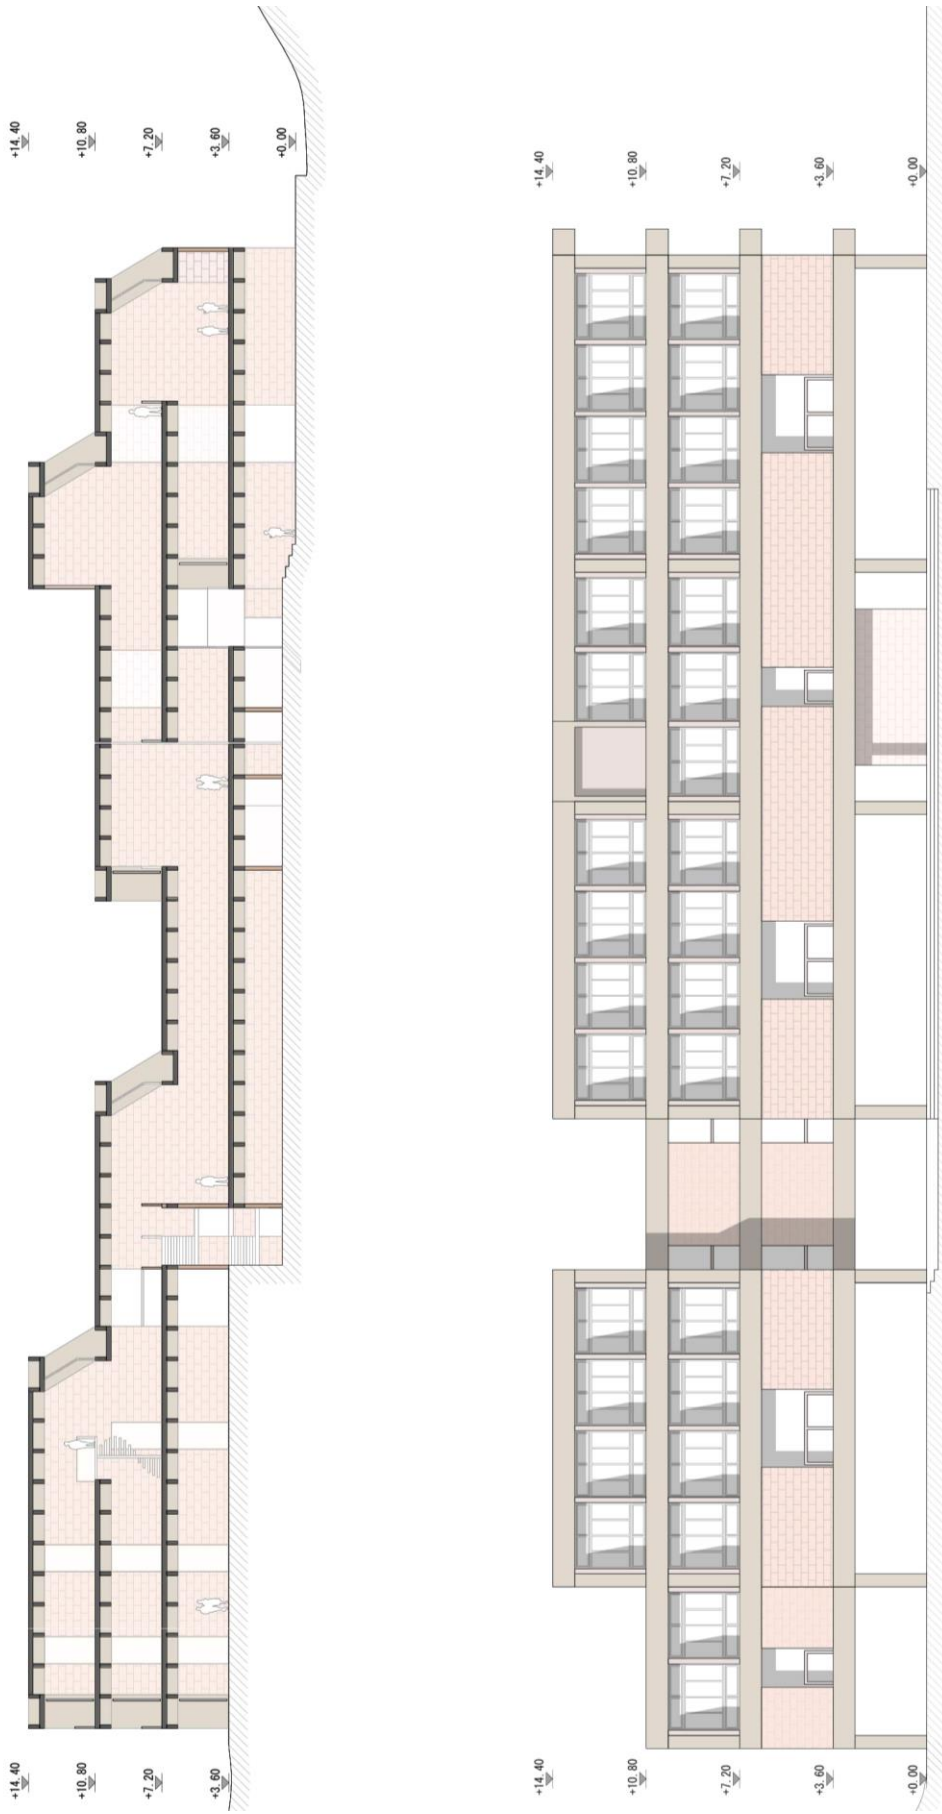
B.V.Doshi - CEPT University – Sección longitudinal e 1:350 y alzado Sur e 1:250
